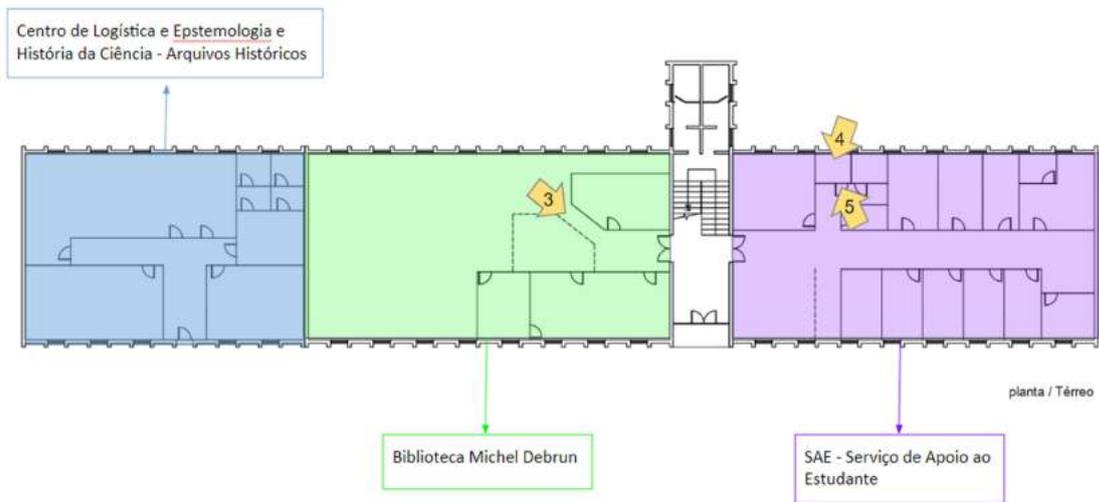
Planta do SAE – pavimento térreo – Montagem Autor: Dutra, P. 2020
